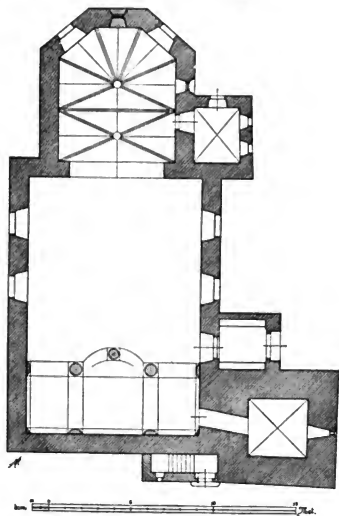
Slivitz. Grundriss der Kirche.
